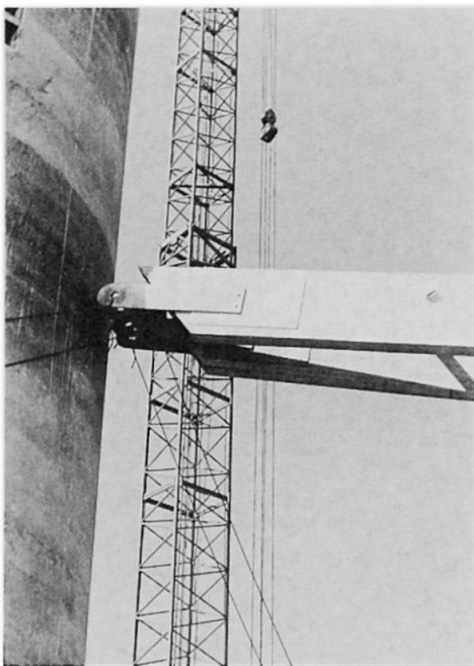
Mit den erforderlichen Anschluss- und Stossverbindungen versehen, werden auf der Baustelle jeweils 3 Brettschichtelemente zu einer 102 m langen Hängerippe montiert
